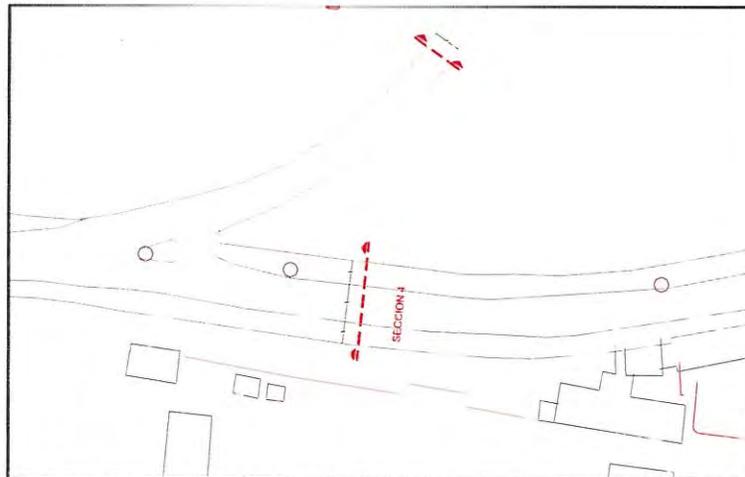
Localización secciones Colegio Militar y Acceso a Auditorio. Fuente: PROYECO.
